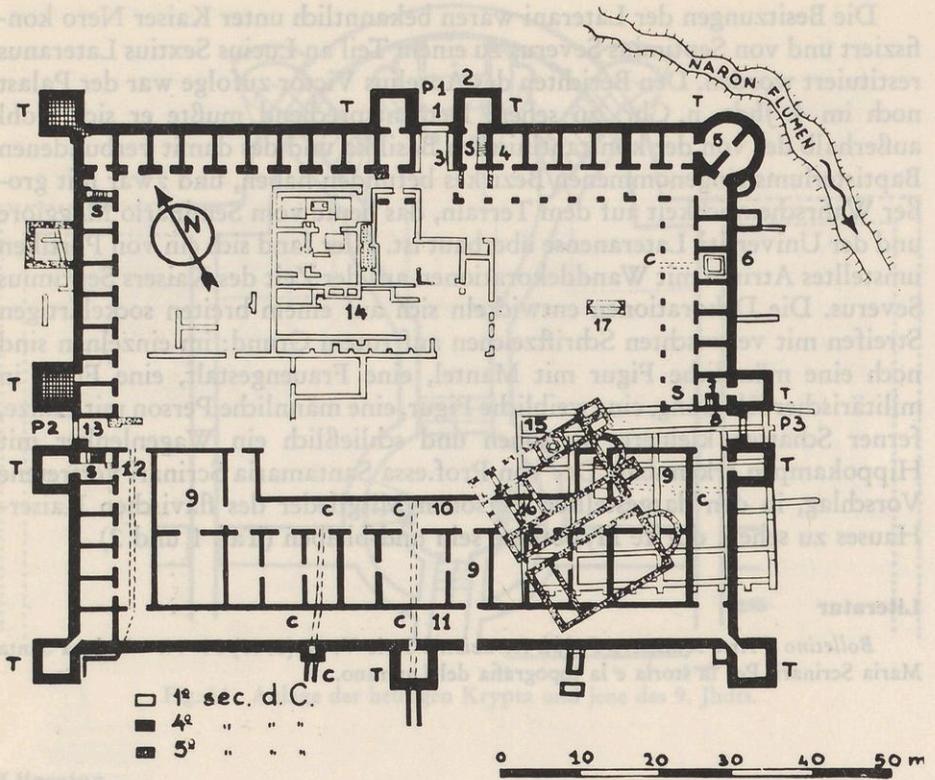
Villa rustica fructuaria mit einer Doppelkirchenanlage. Plan
